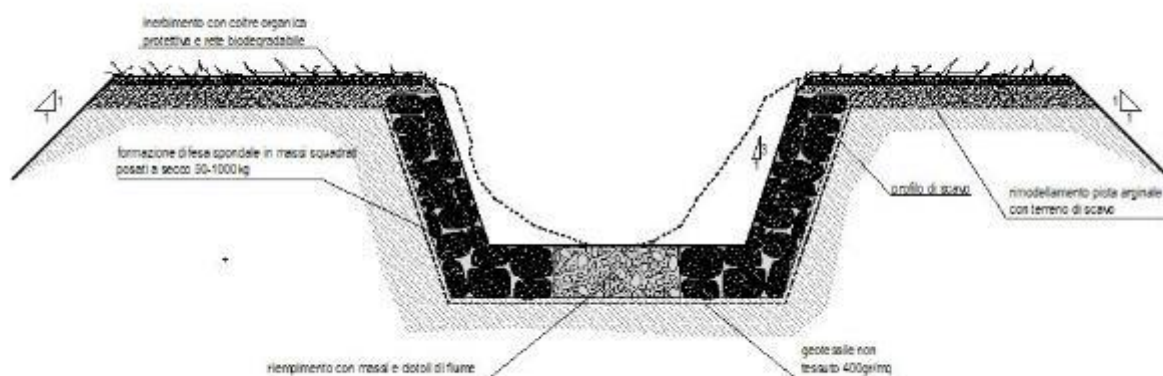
INTERVENTO DI PROGETTO, SEZIONE TIPOLOGICA 3 "CANALE IN PIETrame SPACCATO A SECCO"
